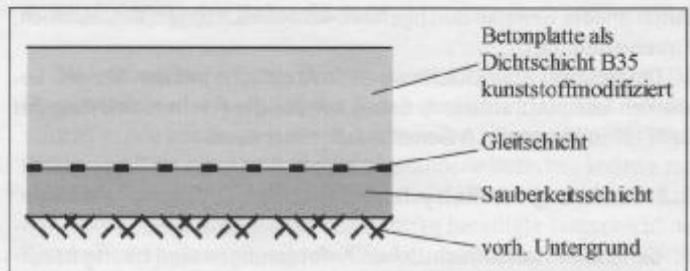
Sanierungsvariante 3 als Ortbetonfläche auf Sauberkeitsschicht und Gleitschicht
